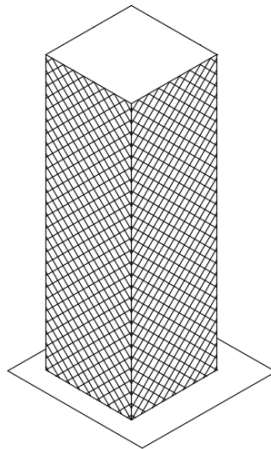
Distribuição de esforços de compressão na fachada a sotavento de um edifício com sistema estrutural tubular e pilares internos
